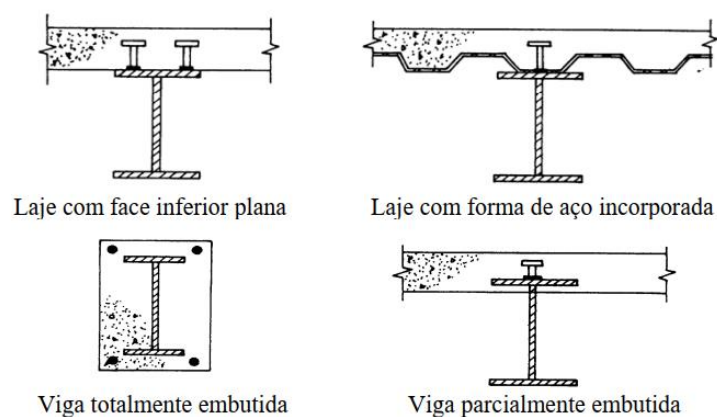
Tipos de vigas mistas aço-concreto. (Fonte: Malite (1990))
